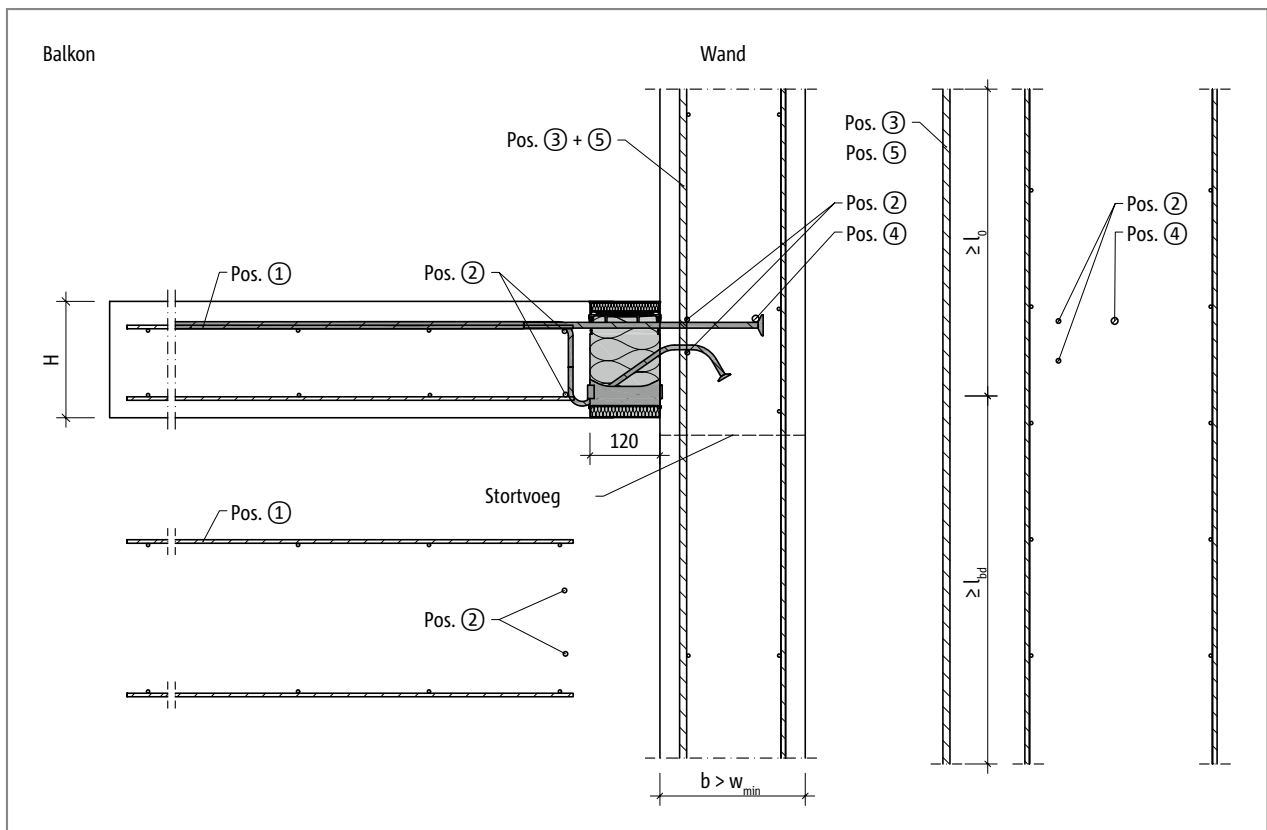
Schöck Isokorb® XT type K-U: bijlegwapening voor lager gelegen balkon aan bouwdeel met grotere afmetingen ($w_{vorth} > w_{min}$)
